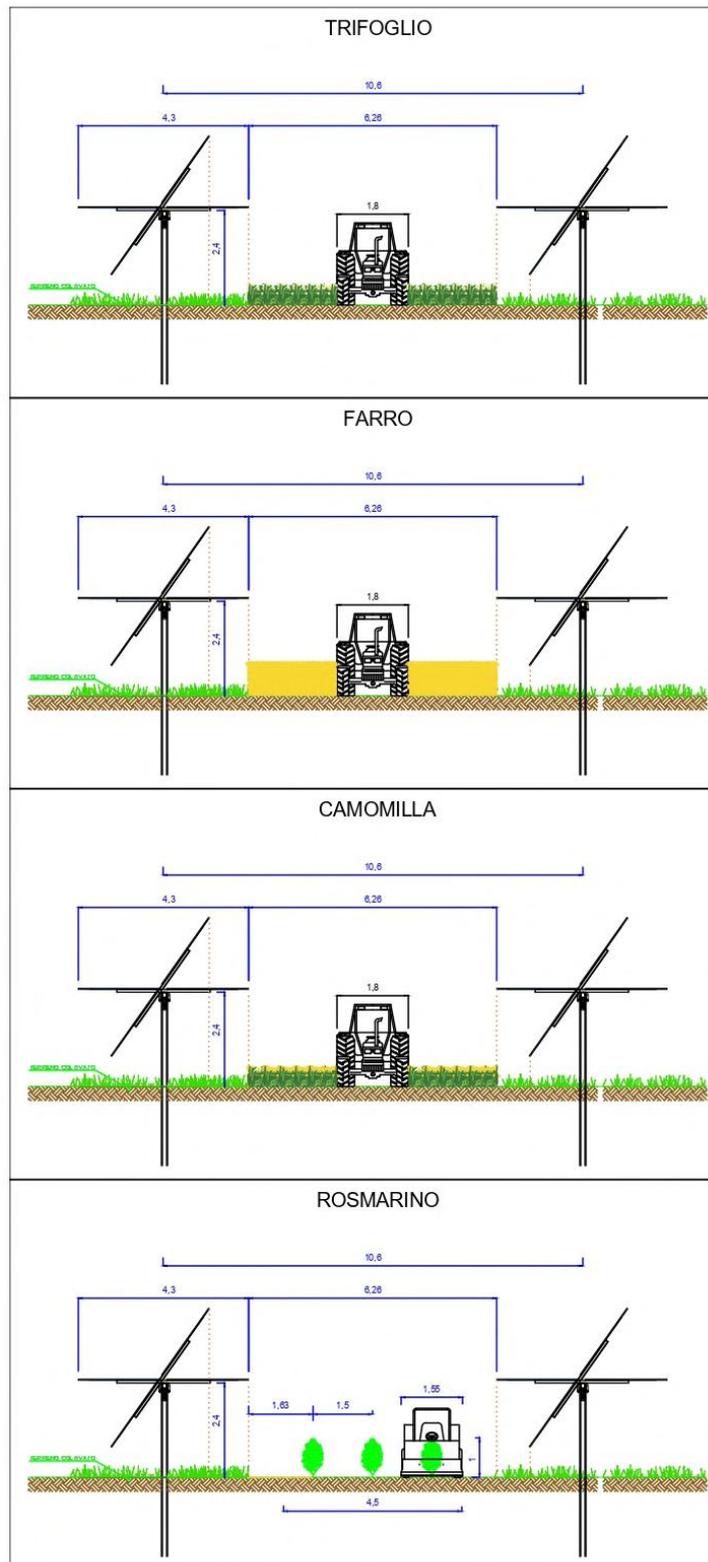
Rappresentazione del prospetto frontale delle colture
